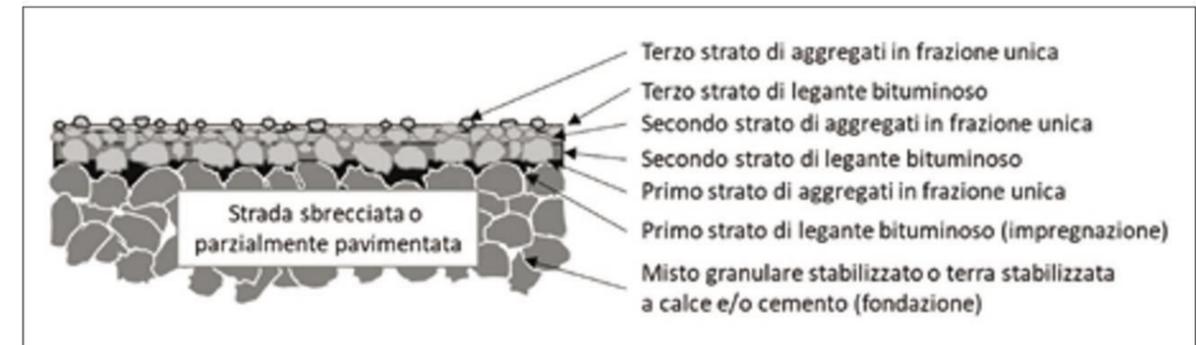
Schema tipico di un intervento di depolverizzazione a tre strati.
